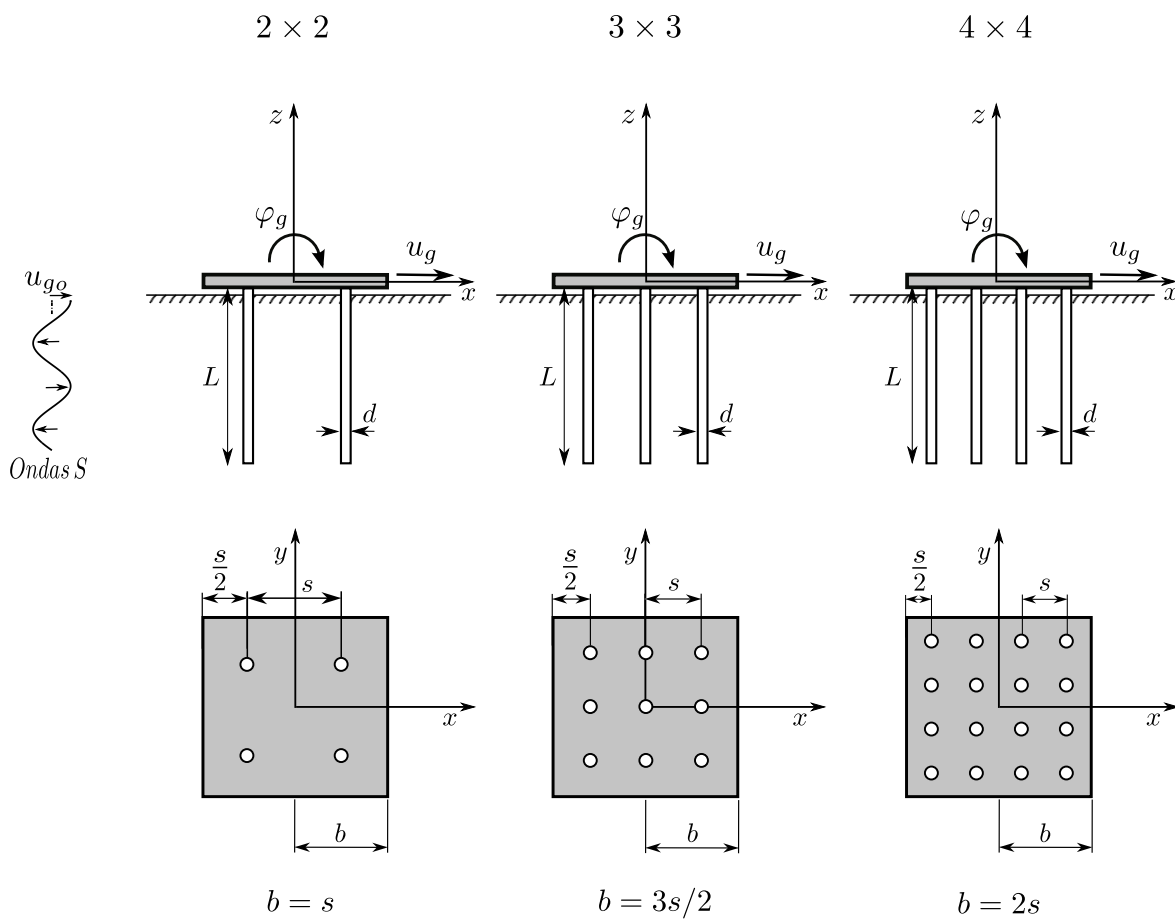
Geometría de las cimentaciones con pilotes verticales.
